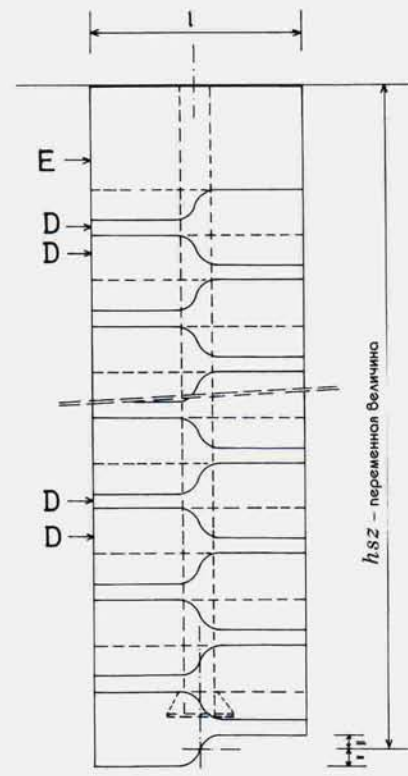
Узловая зарисовка сборной деревянной лестницы с оригинальной металлической несущей конструкцией (схема ее сборки)
